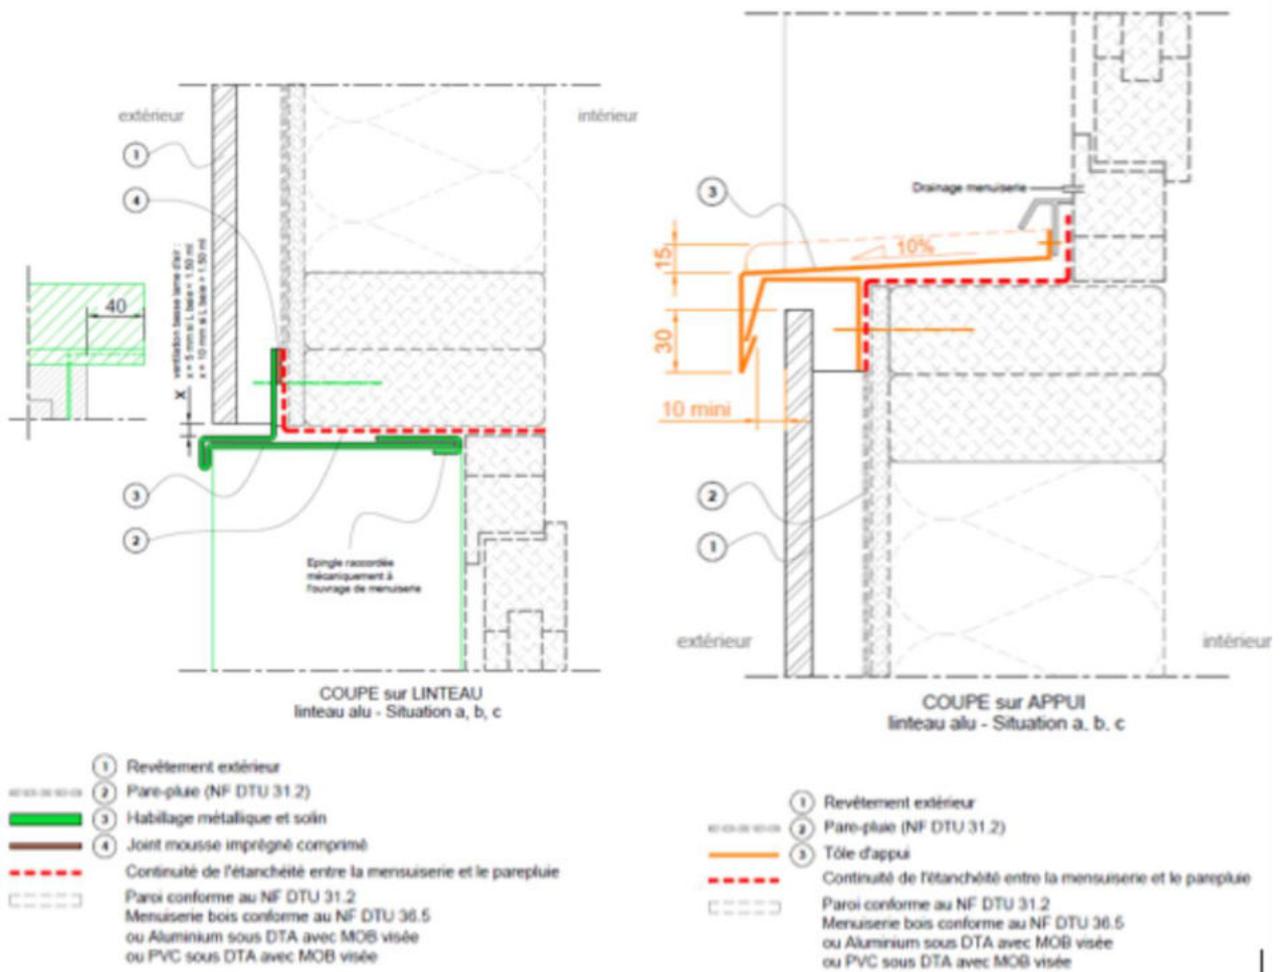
Pose sur COB- Coupe sur linteau et appui de baie
